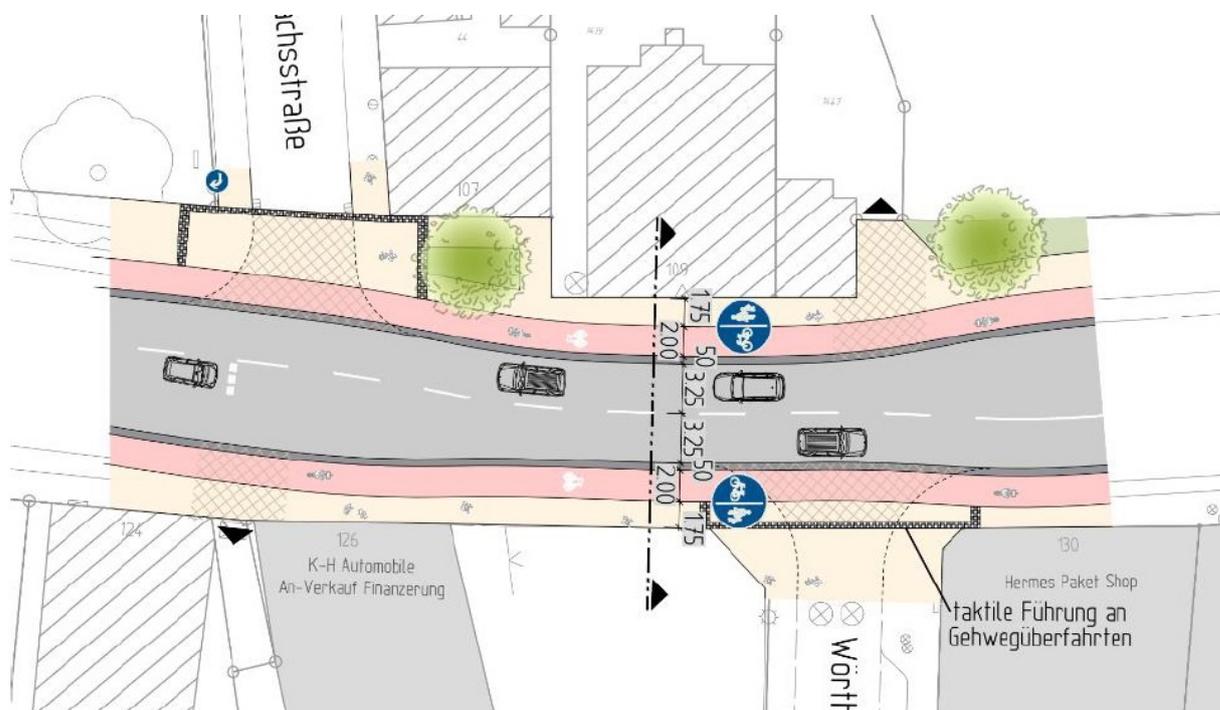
Lageplan Engstelle im Bereich Flachsstraße
